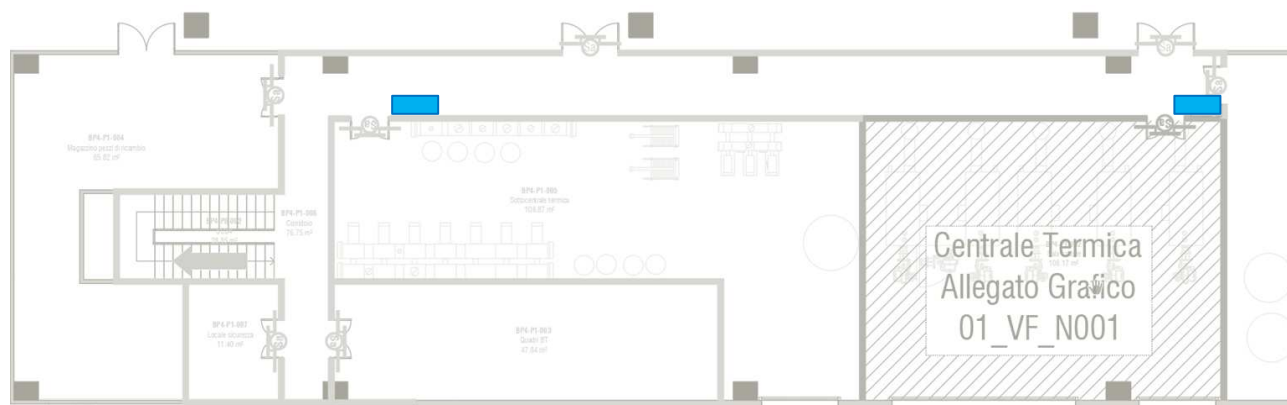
Estratto planimetria 01\_VF\_D002\_22\_5079\_P1-P2, del piano primo palazzina BP4
